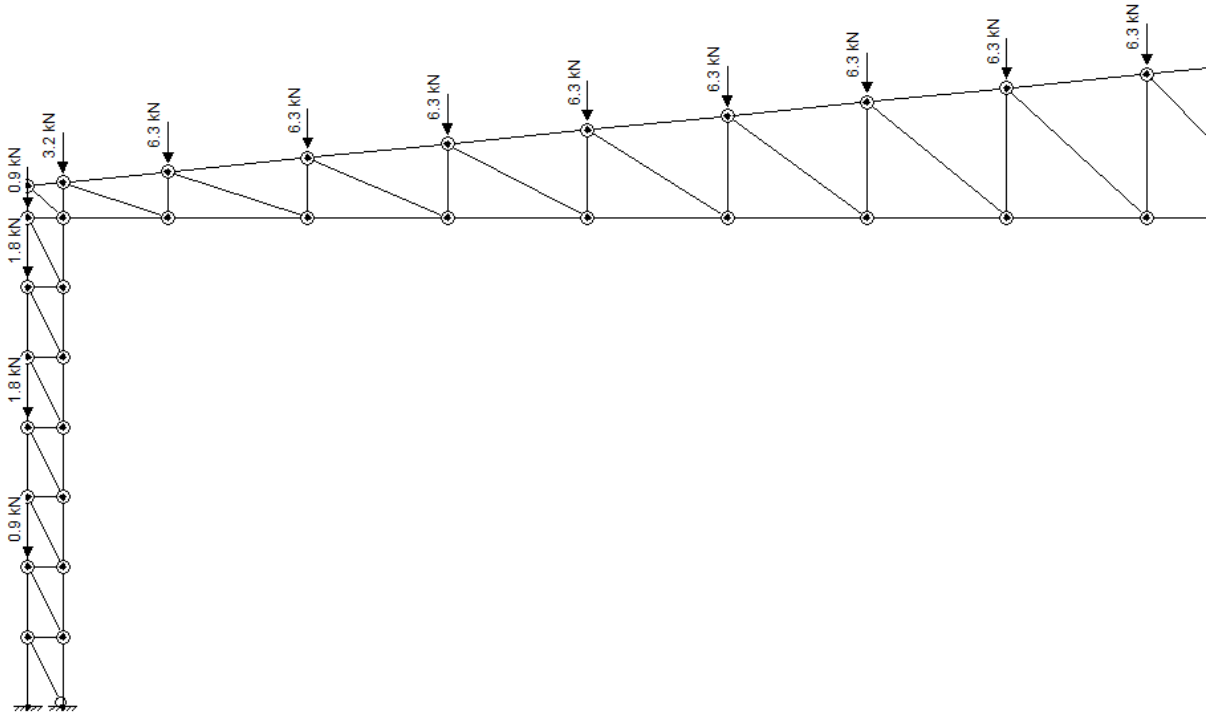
Condições de contorno e cargas pórtico apoio topo no pilar
